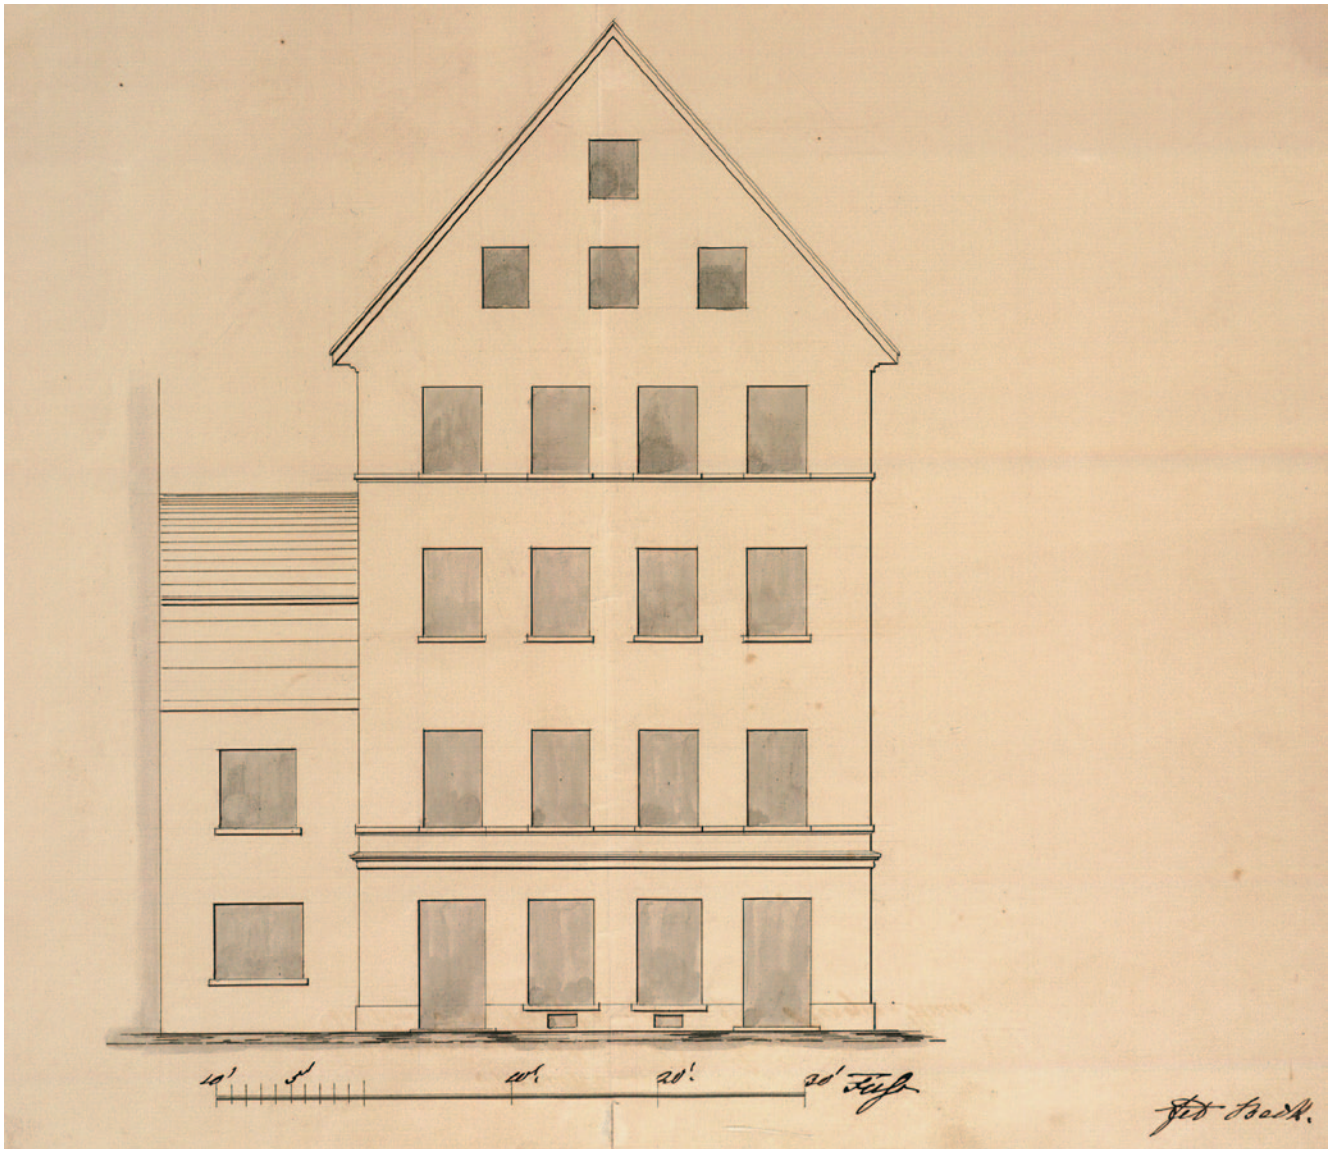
Gebäude Lange Straße 12 (A 259), Ansicht der neuzubauenden Hausseite zur Langen Straße, Baugesuch 1848.
